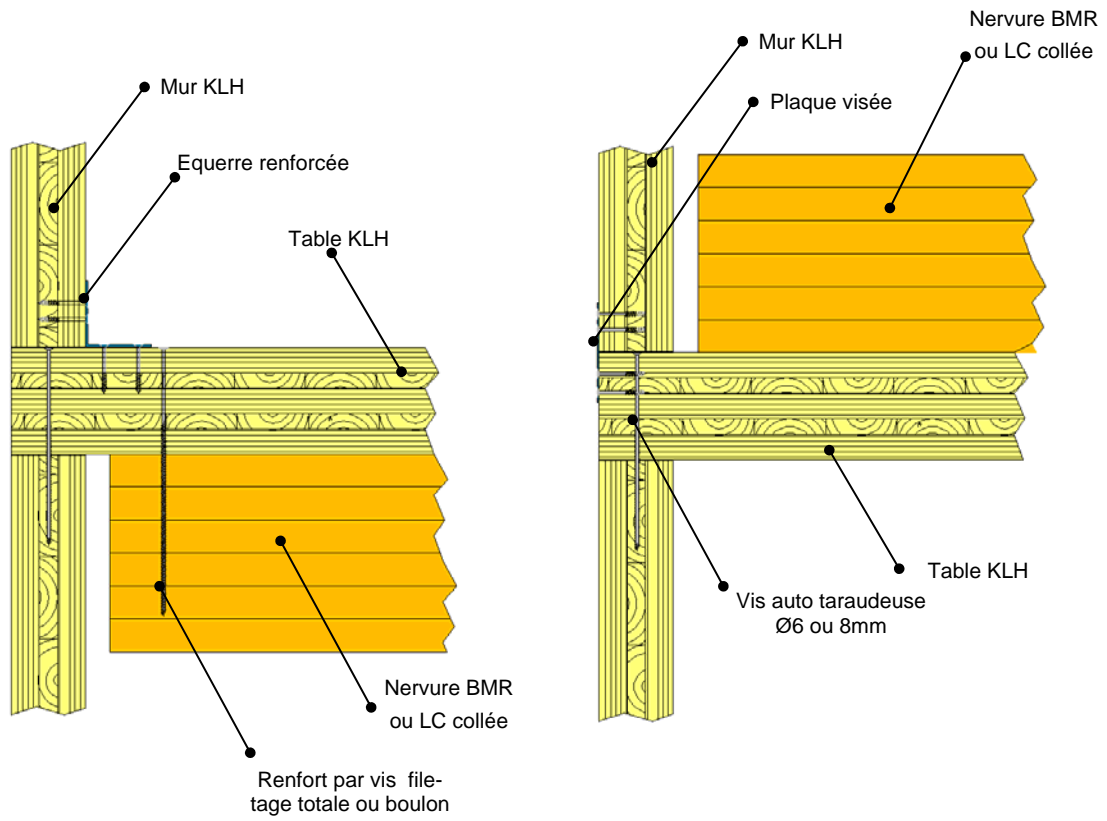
Coupe verticale sur locaux mitoyens et superposés avec plancher filant
